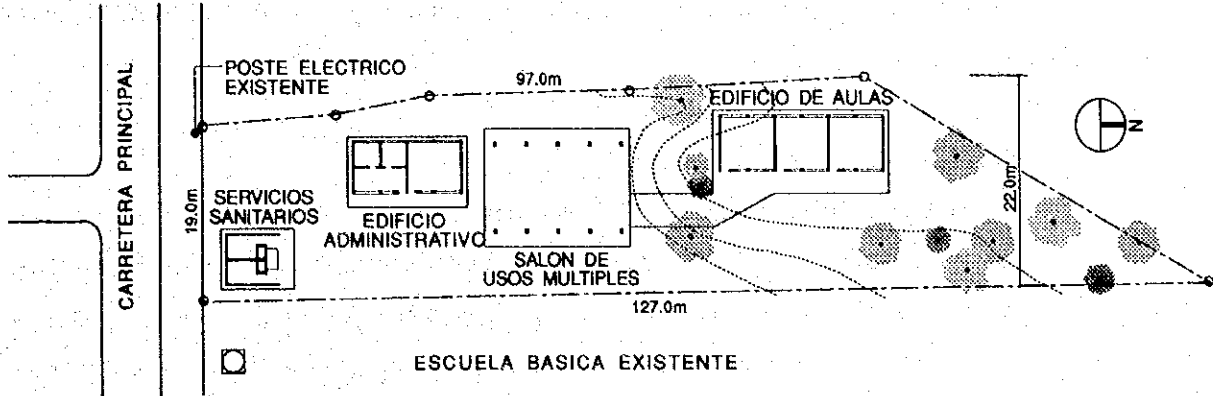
PLAN GENERAL DE DISPOSICION DEL INSTITUTO NACIONAL DE SAN ILDEFONSO
